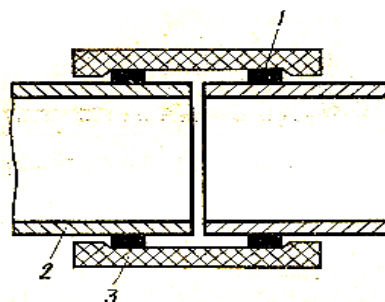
Îmbinarea tuburilor din asbociment cu mufă cilindrică și inele din cauciuc: 1 – inel din cauciuc; 2 – tub; 3 – mufă din asbociment
